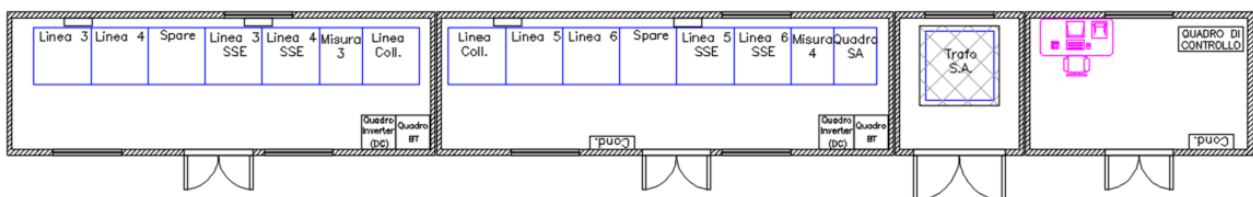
Planimetria quadro di raccolta e misura: zona 2
